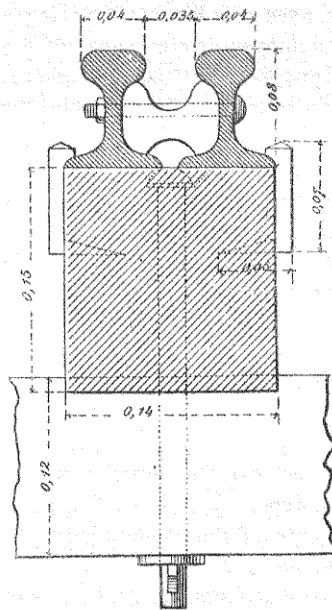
Tramway de Villiers-le-Bel. Profil en traverse. Échelle 1/5.
